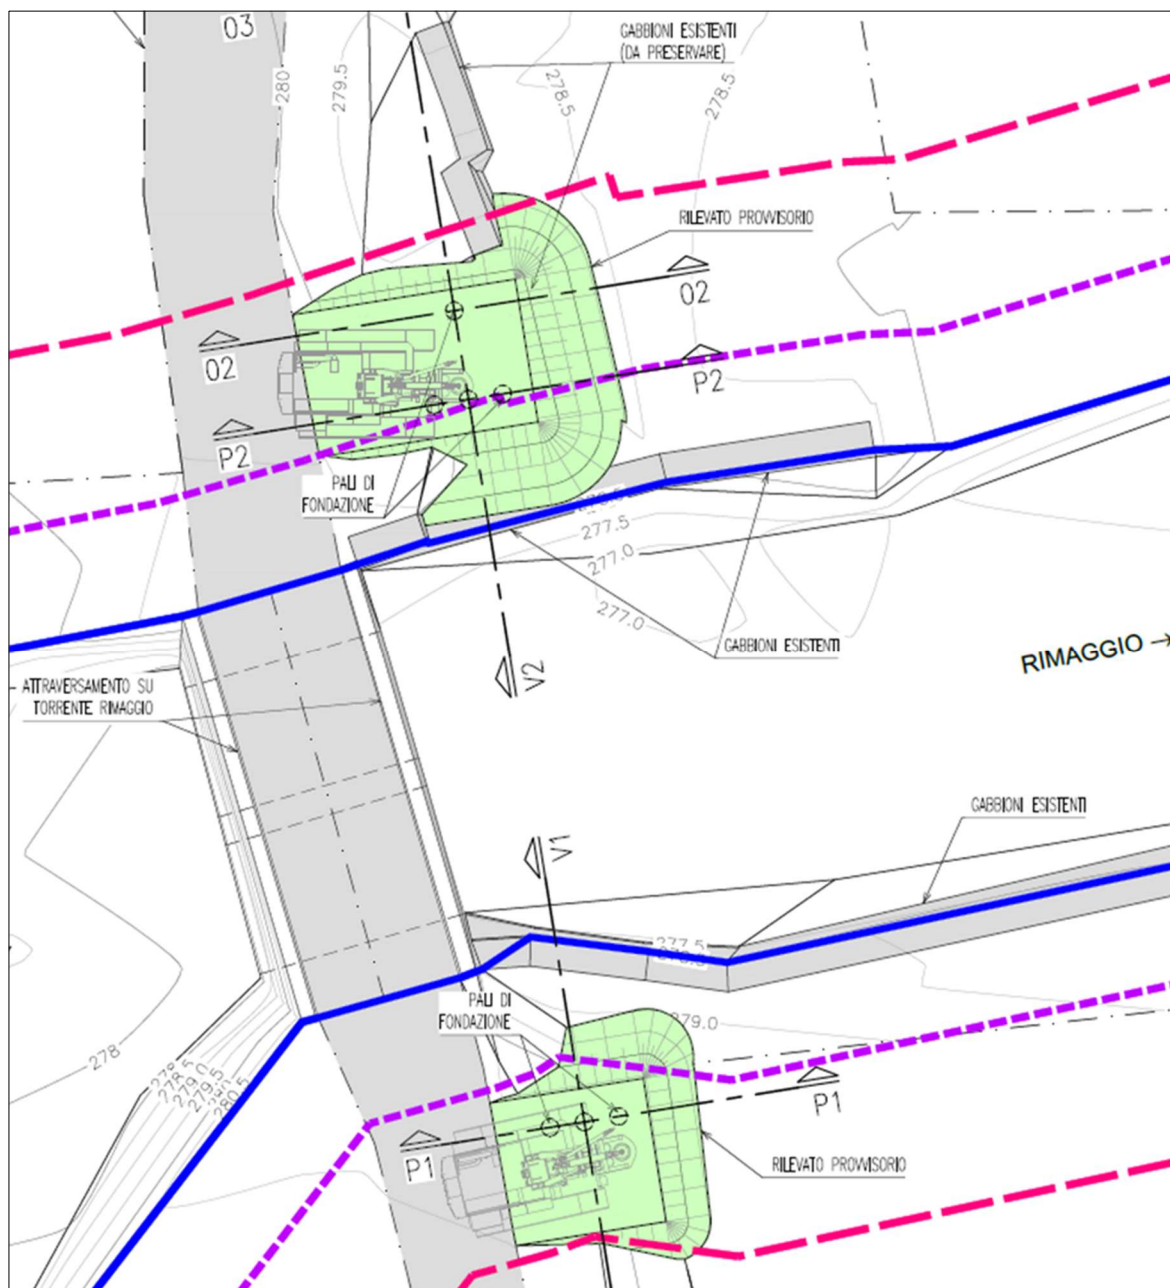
Stralcio planimetrico fase di esecuzione delle sottofondazioni, in verde le aree in rilevato provvisorio
